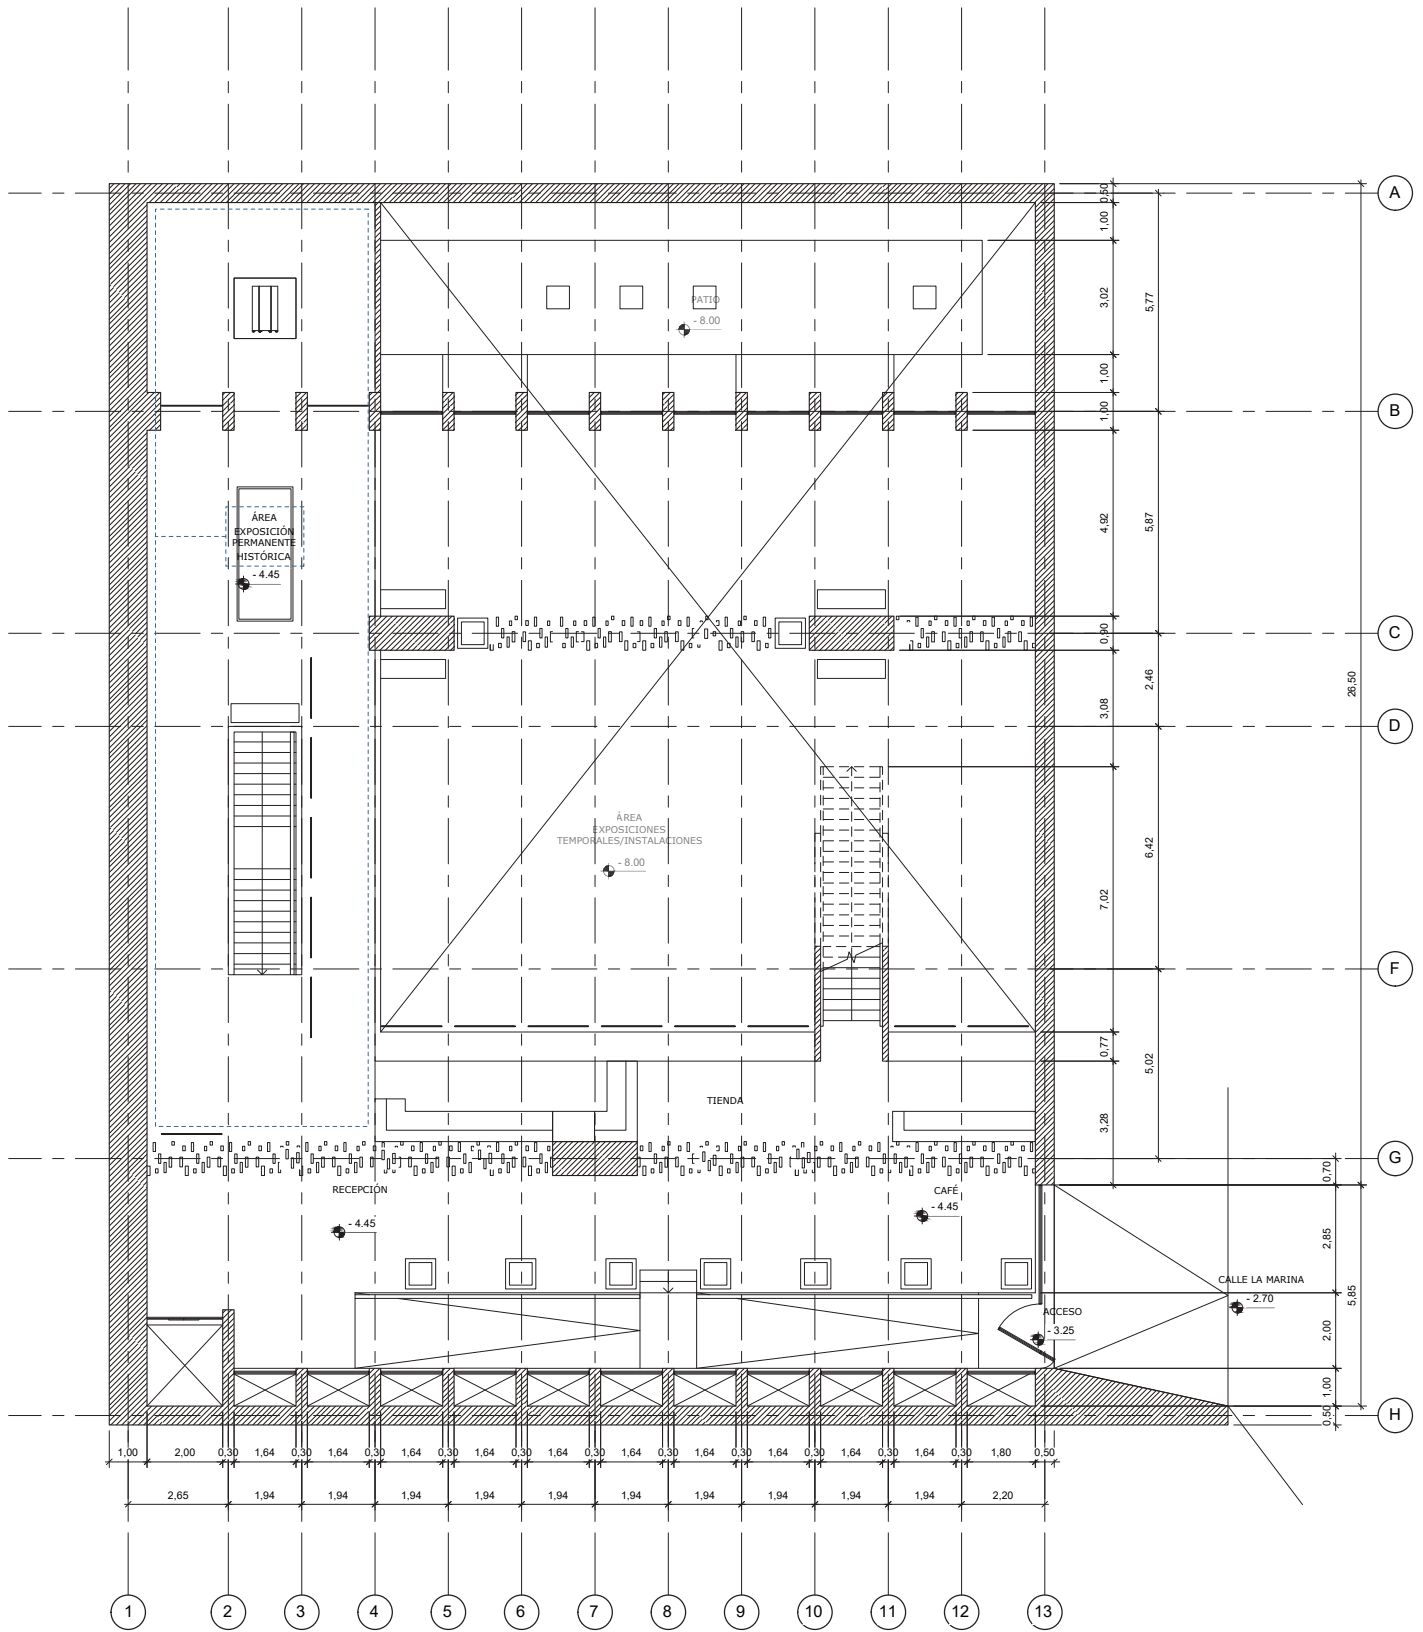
Planta nivel -1. Esc.1:200. PRELIMINAR.
